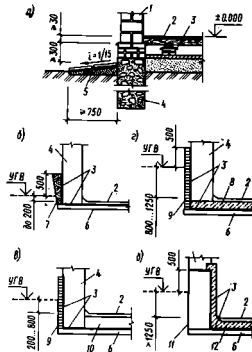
Защита элементов малоэтажных зданий от влаги грунтов:
